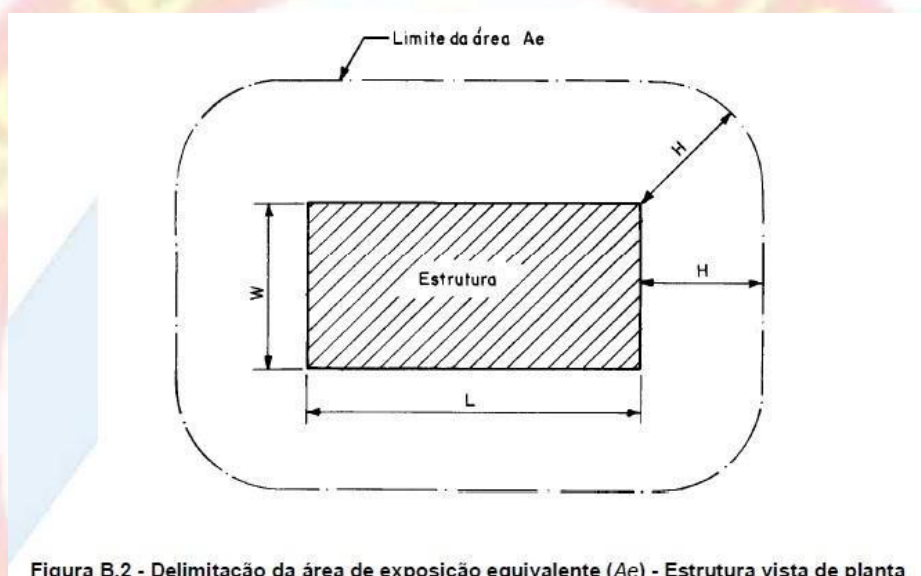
Delimitação da área de exposição equivalente (A_e) - Estrutura vista de planta
